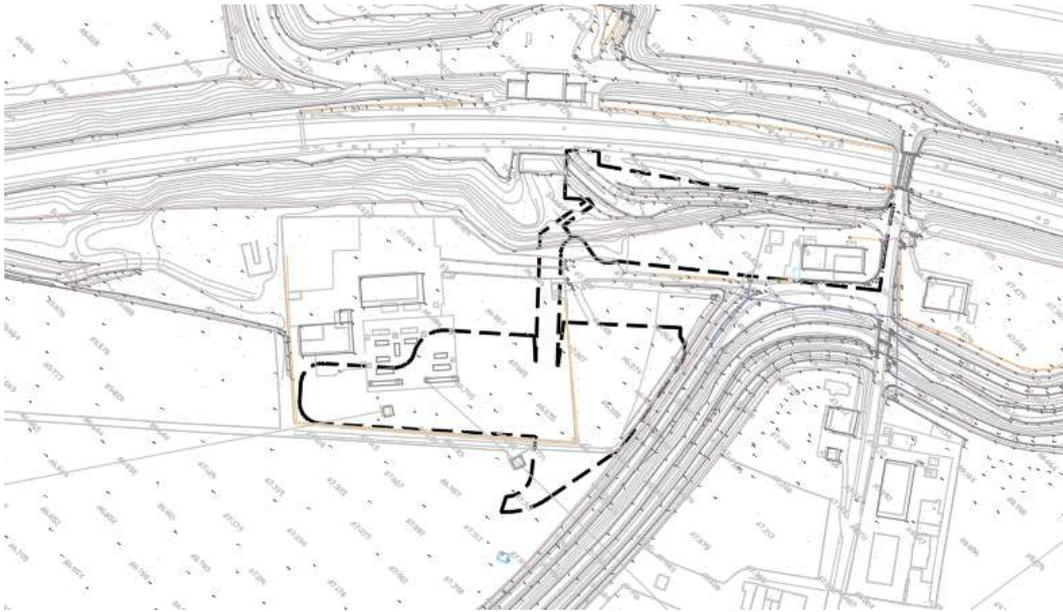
Estratto planimetrico dello stato di fatto – Individuazione dell'area oggetto di intervento con polilinea nera tratteggiata.
